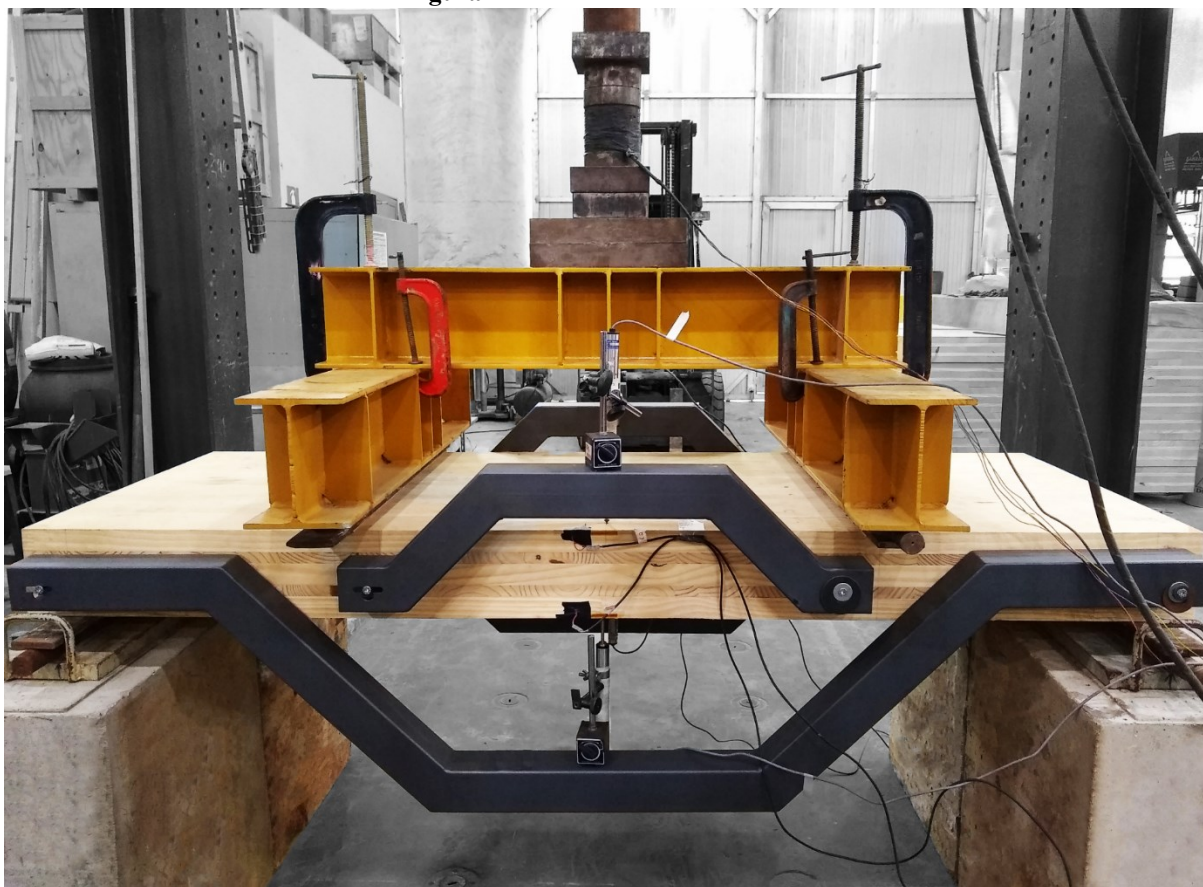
Detalhamento da instrumentação, equipamentos e dimensões do ensaio PFP-B, medidas em milímetros.
